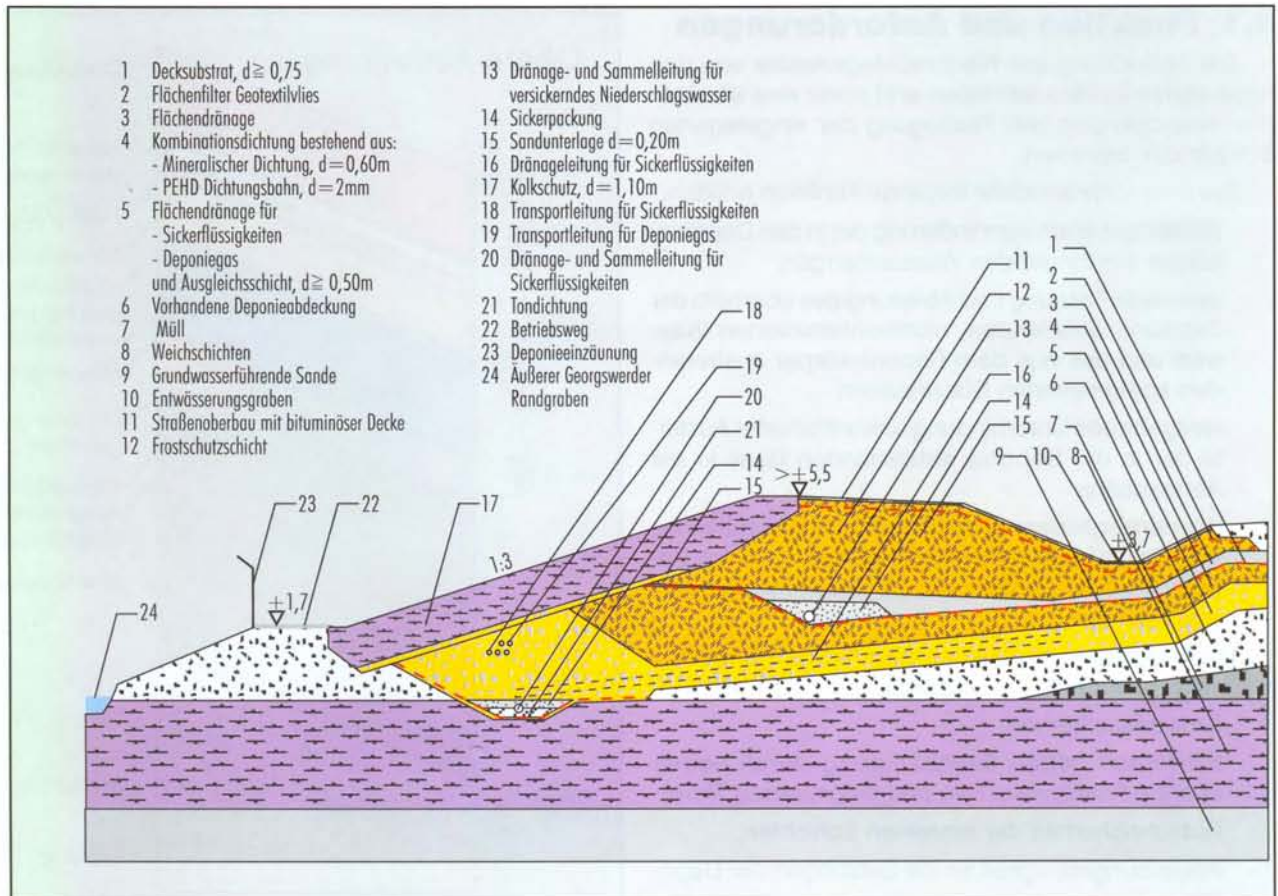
Fußpunktausbildung mit Schichtaufbau der Unteren Abdeckung
